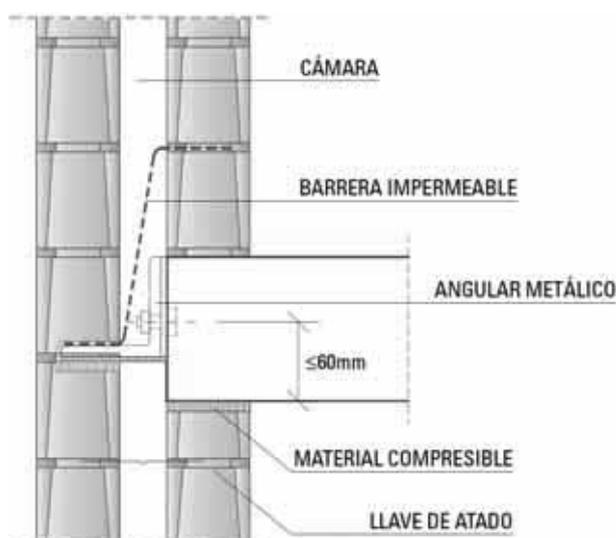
Hoja exterior de fábrica vista pasante por delante de la estructura.
